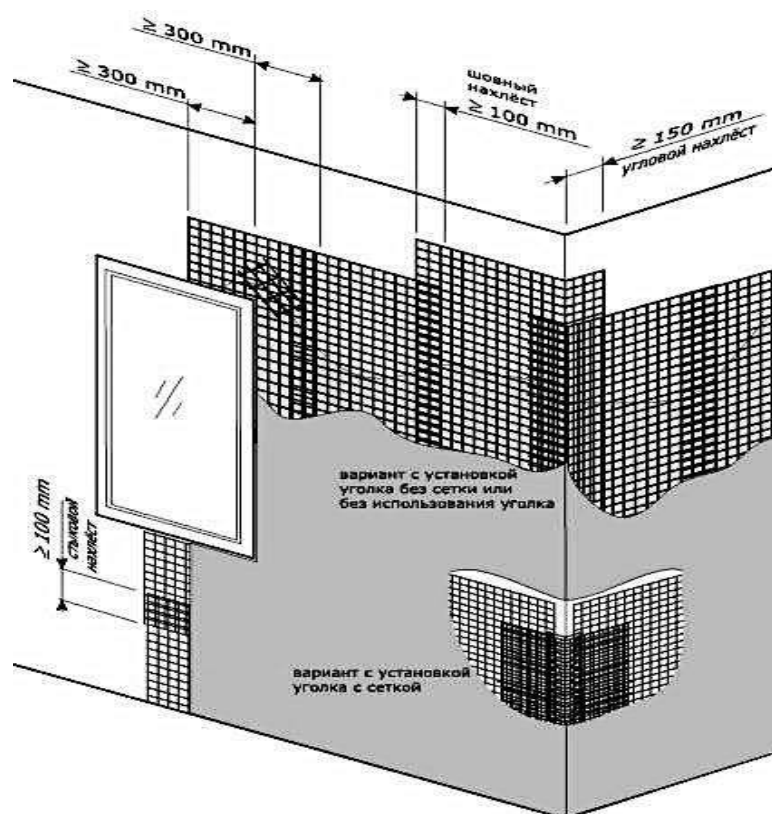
Армирование теплоизоляционных плит стеклосеткой
